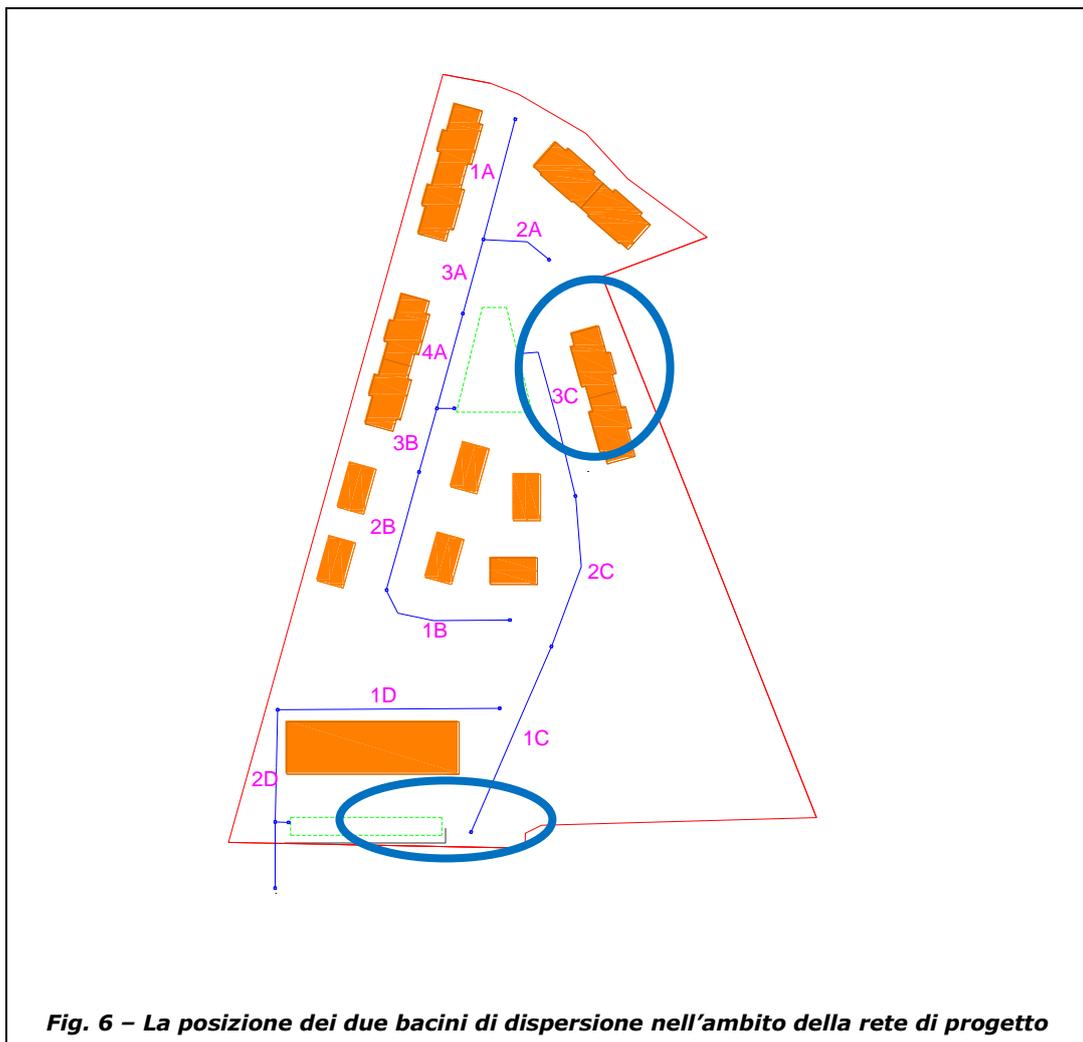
La posizione dei due bacini di dispersione nell'ambito della rete di progetto
